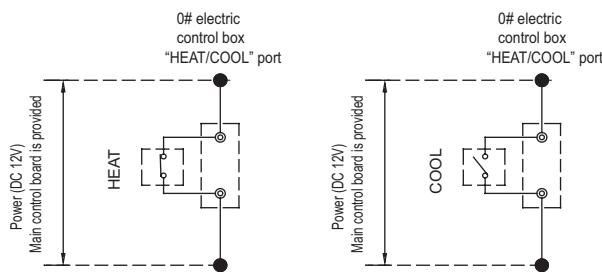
Cablagem da porta elétrica "HEAT/COOL" fraca
